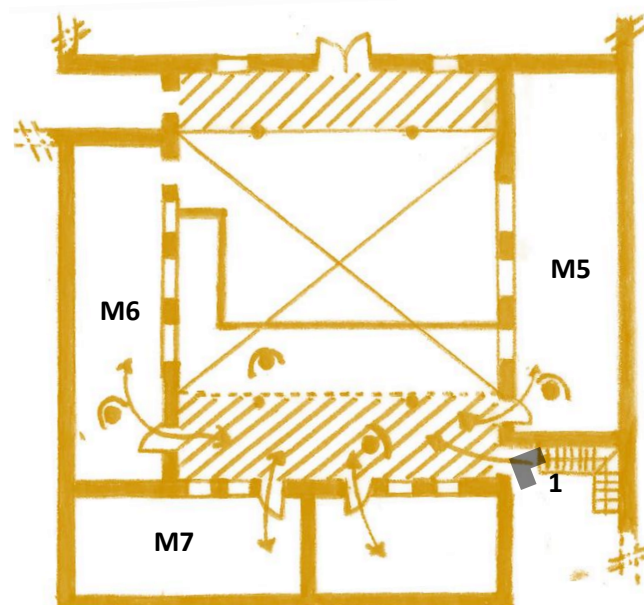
Croquis de plan du rez-de-chaussée - maison oukalisée (2)
